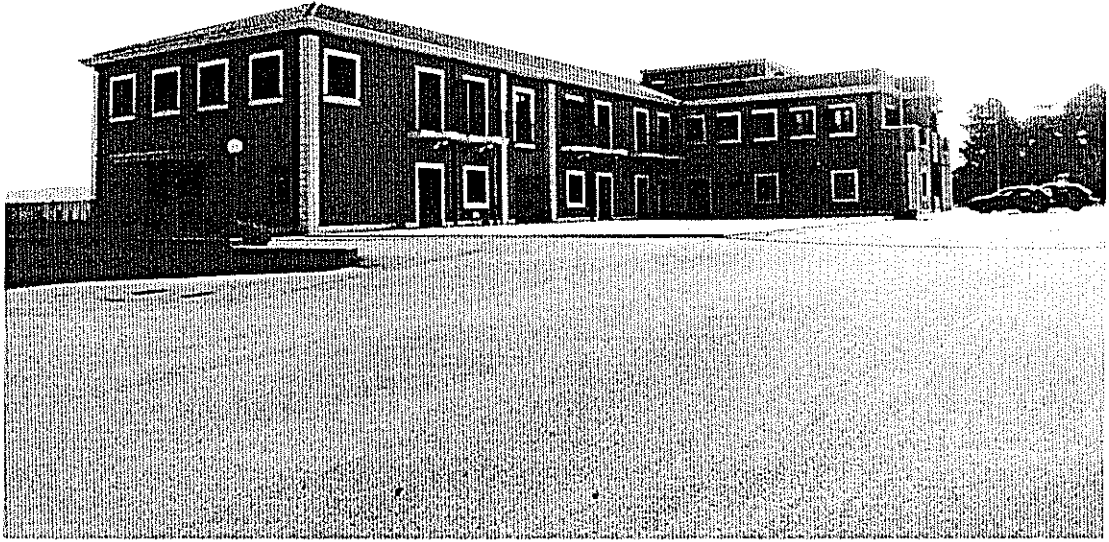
Vista del primo corpo di fabbrica dalla corte esterna.
